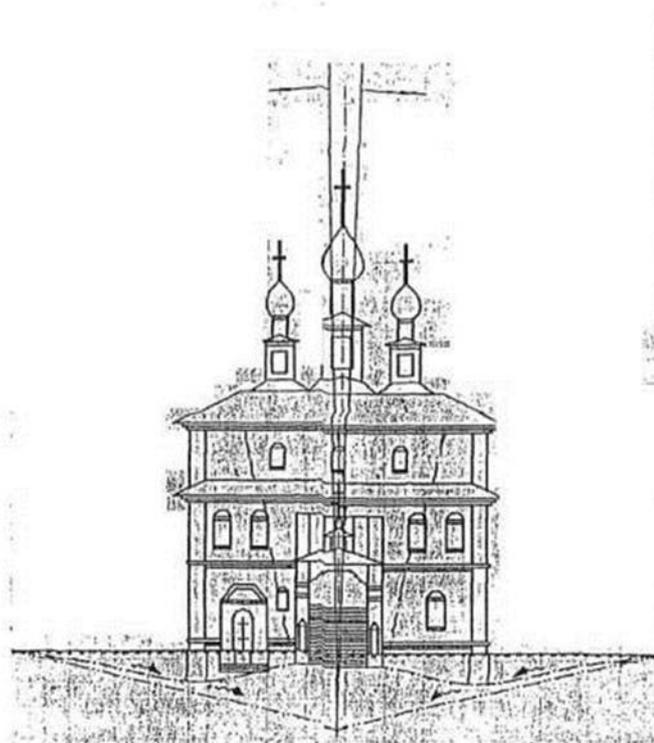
Схема деформации грунтов основания древних зданий с изменением гидрологических условий при миграционном подтоплении фундаментов подземными водами верховодки⁹:
